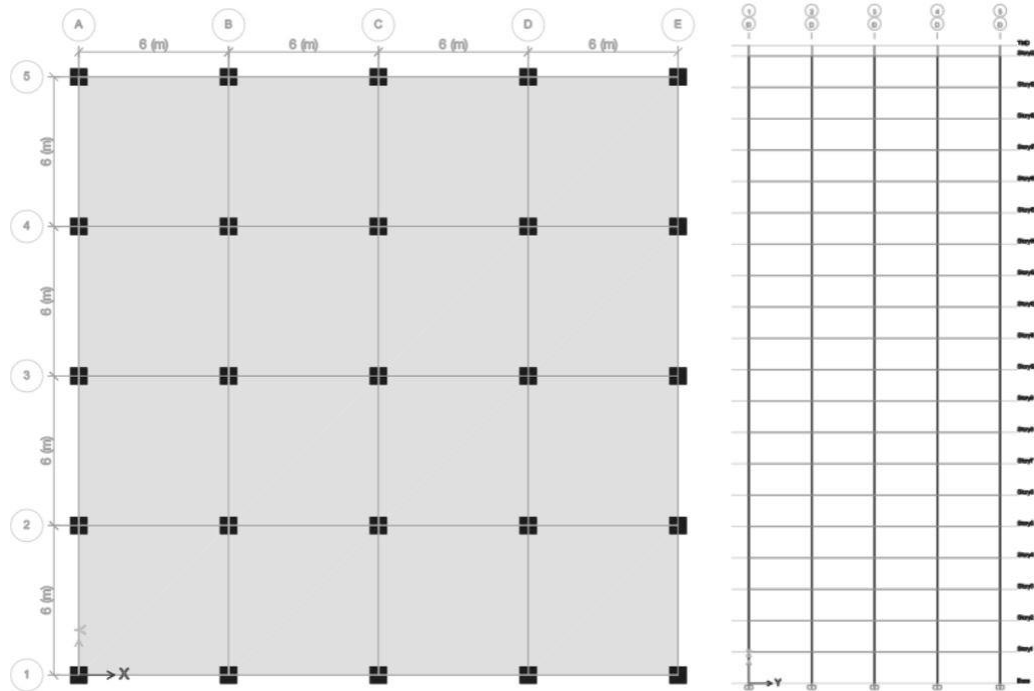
Planta y elevación típica del edificio (Nivel 1 a nivel 20)
